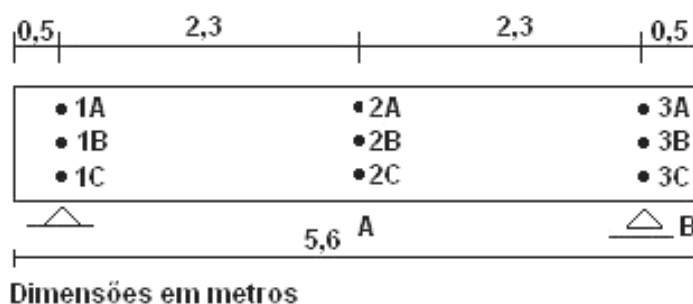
Posicionamento dos pontos de aquisição de temperatura para a viga armada retangular – VR 20 x 45
